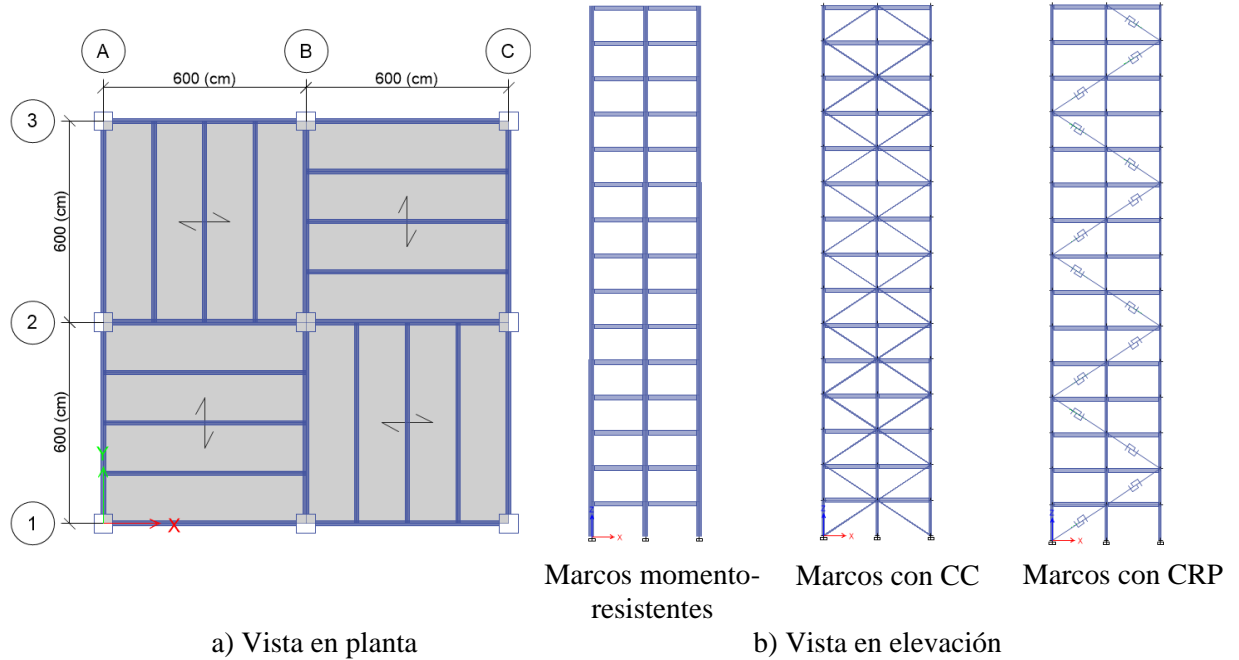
Vista en planta de edificio en estudio de 15 niveles
